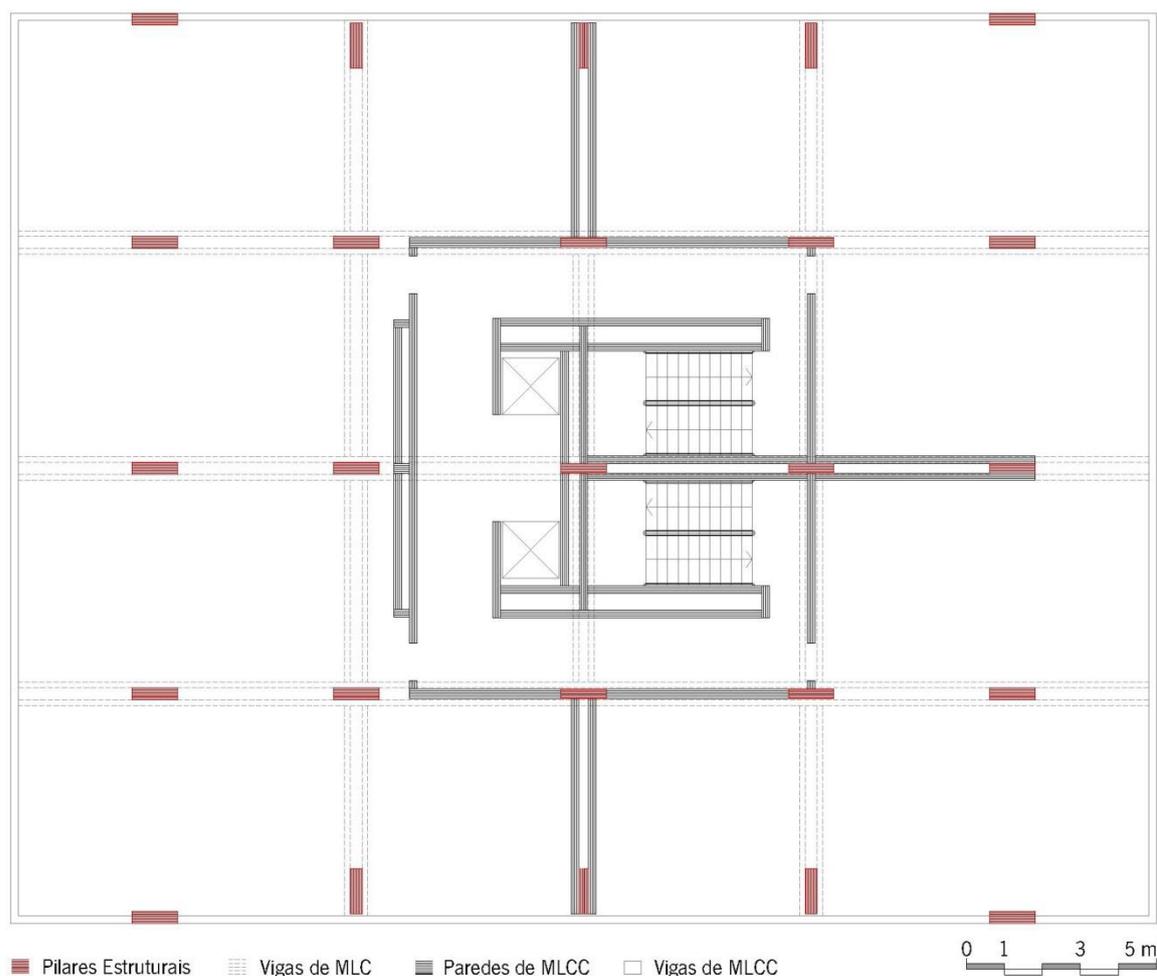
Planta de Piso-tipo com Elementos Estruturais do Tipo MLCC 320 mm L8s-2 ²⁶
